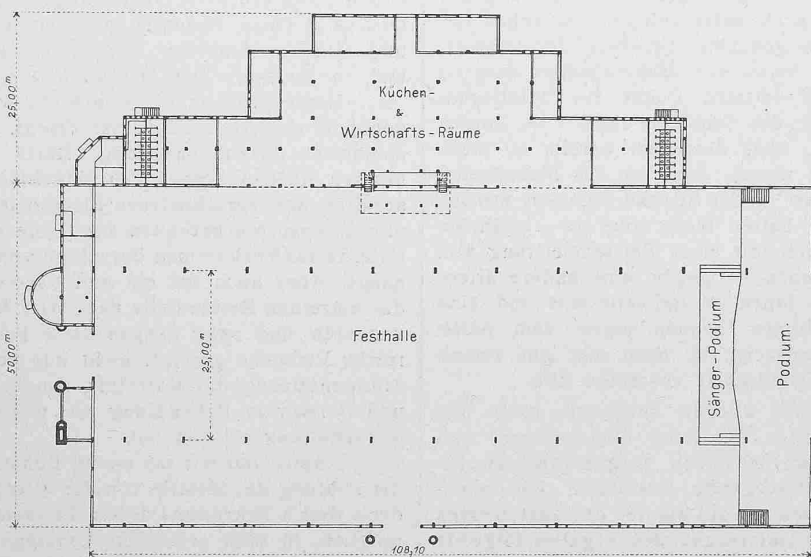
Grundriss. — Masstab 1:1000.
